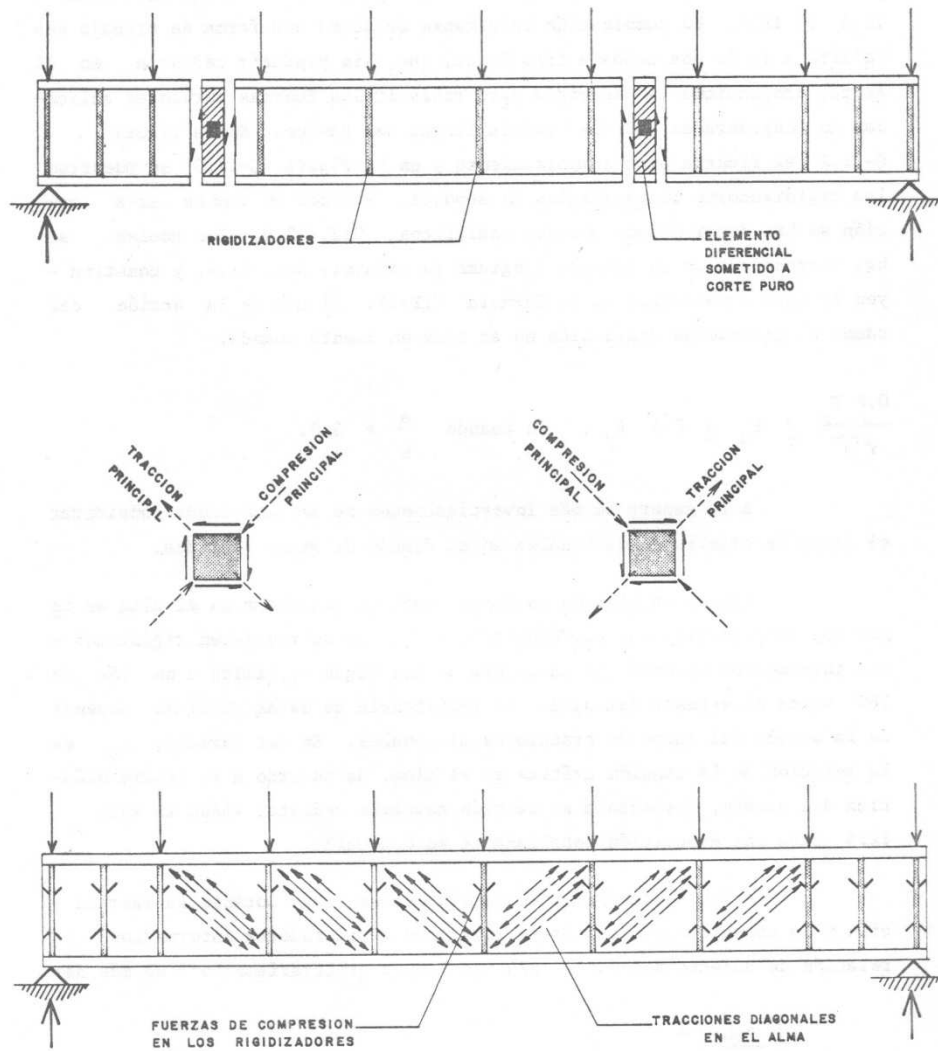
ILUSTRACION DE LA ACCION DEL CAMPO DE TRACCIONES DIAGONALES EN UNA VIGA ARMADA
